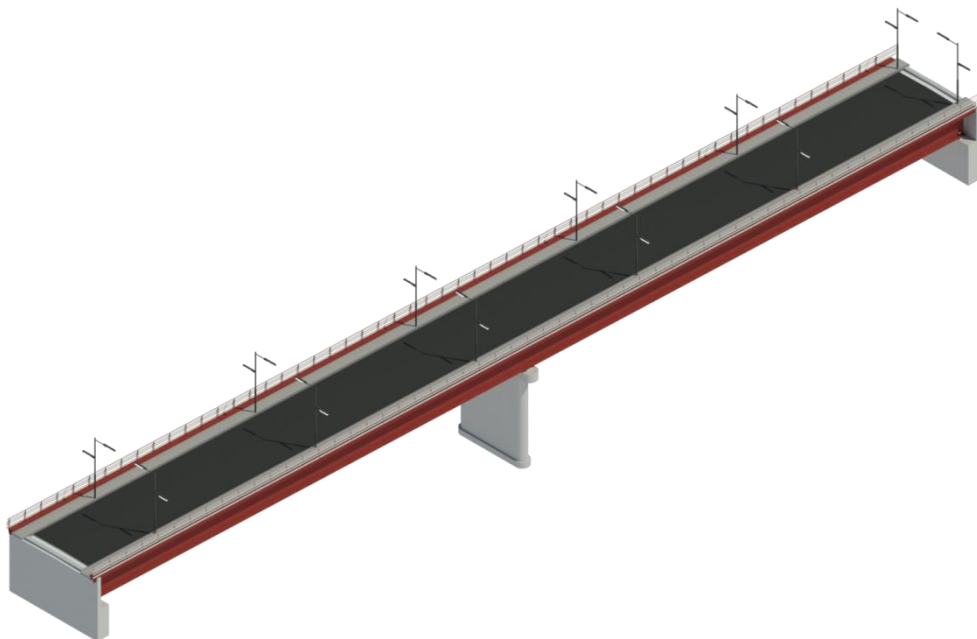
Modello BIM della seconda proposta progettuale, vista assonometrica
